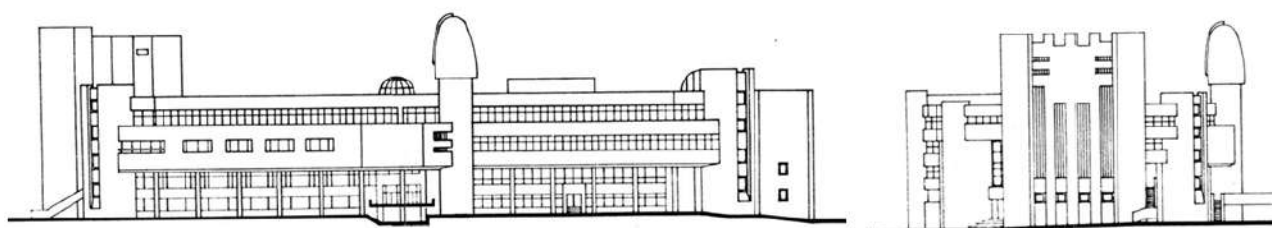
Головний фасад (ліворуч) та бічний фасад (праворуч)
